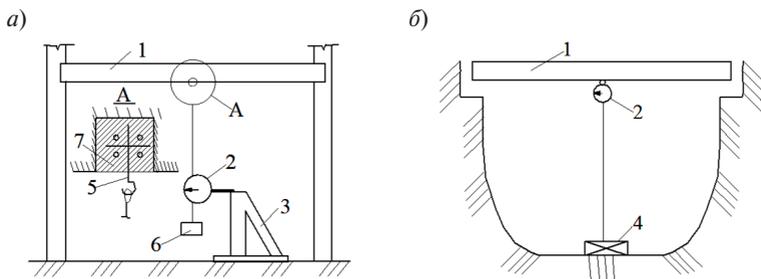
Установка прогибомеров с проволоочной связью: а — установка прогибомеров на независимой опоре; б — установка прогибомера на конструкцию; 1 — испытываемая конструкция; 2 — прогибомер; 3 — опора; 4 — якорь; 5 — фиксатор; 6 — груз; 7 — свинцовая пробка
